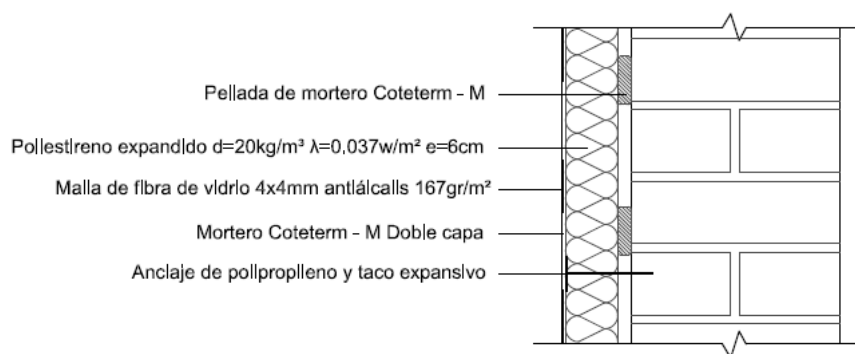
Sección constructiva del sistema SATE colocado en la fachada.
